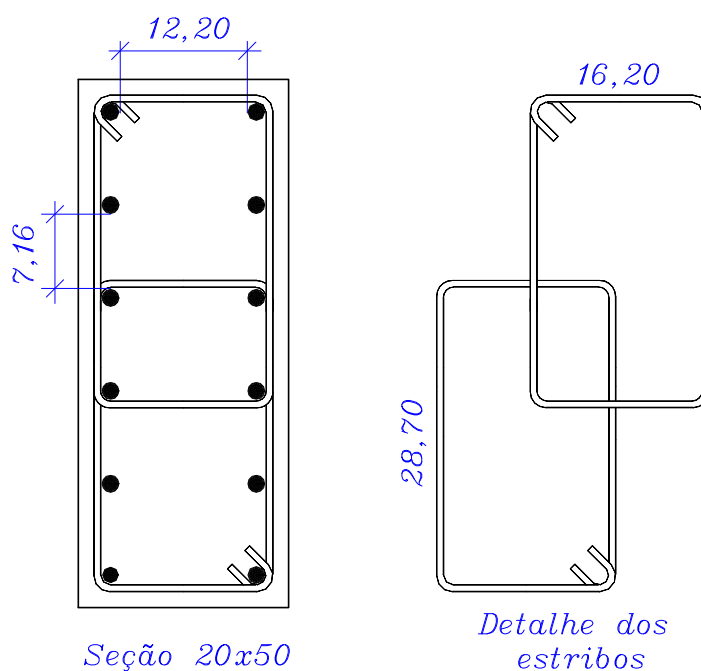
Arranjo inicial de armaduras para o pilar P2
